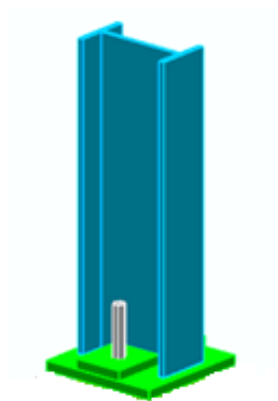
Pormenor em 3D da ligação na base s do Pilar Rotulado
